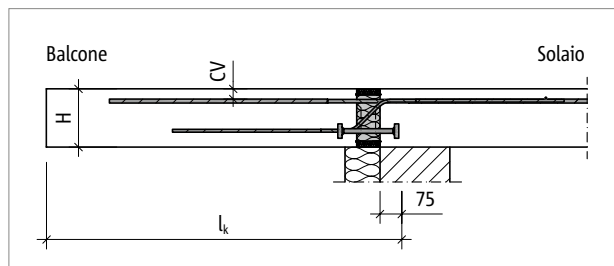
Schöck Isokorb® T tipo K-M12: schema statico
